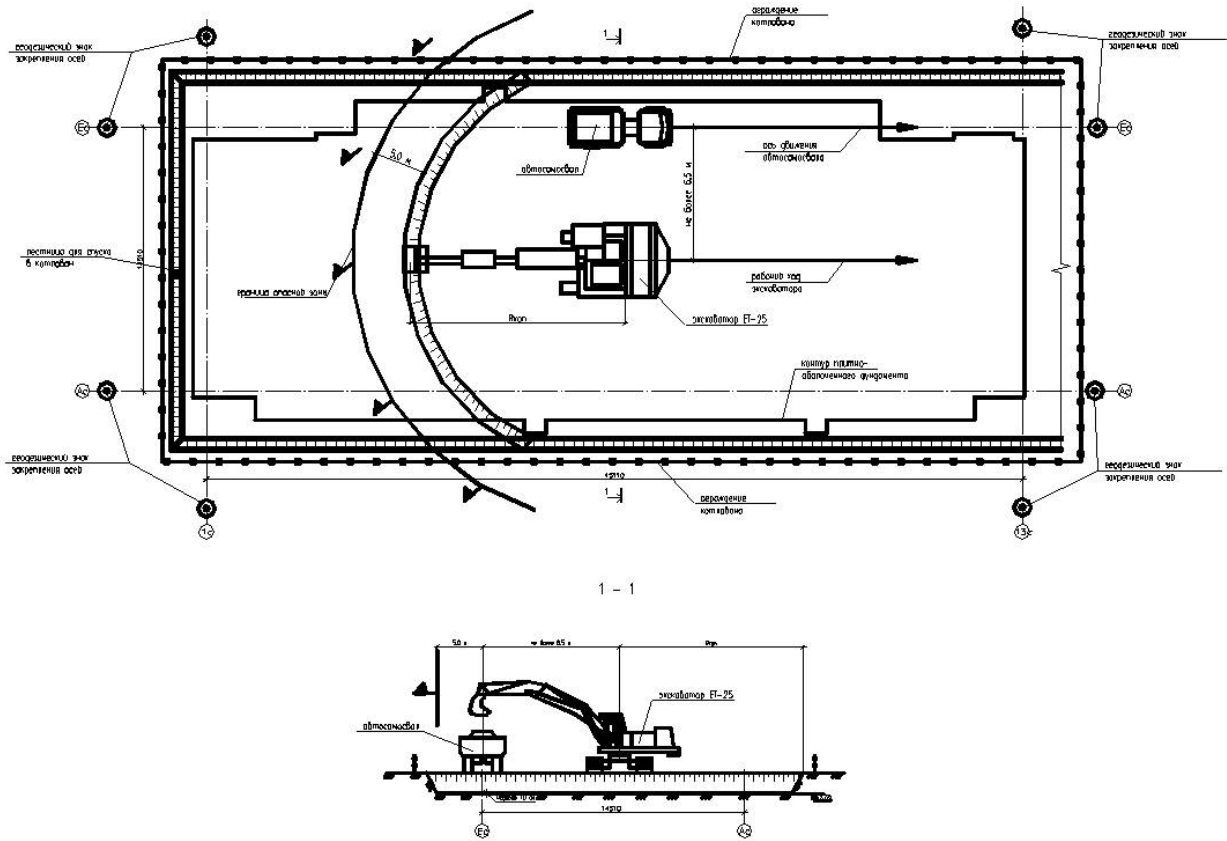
Схема разработки грунта котлована экскаватором, оборудованным ковшом обратная лопата при лобовой проходке
